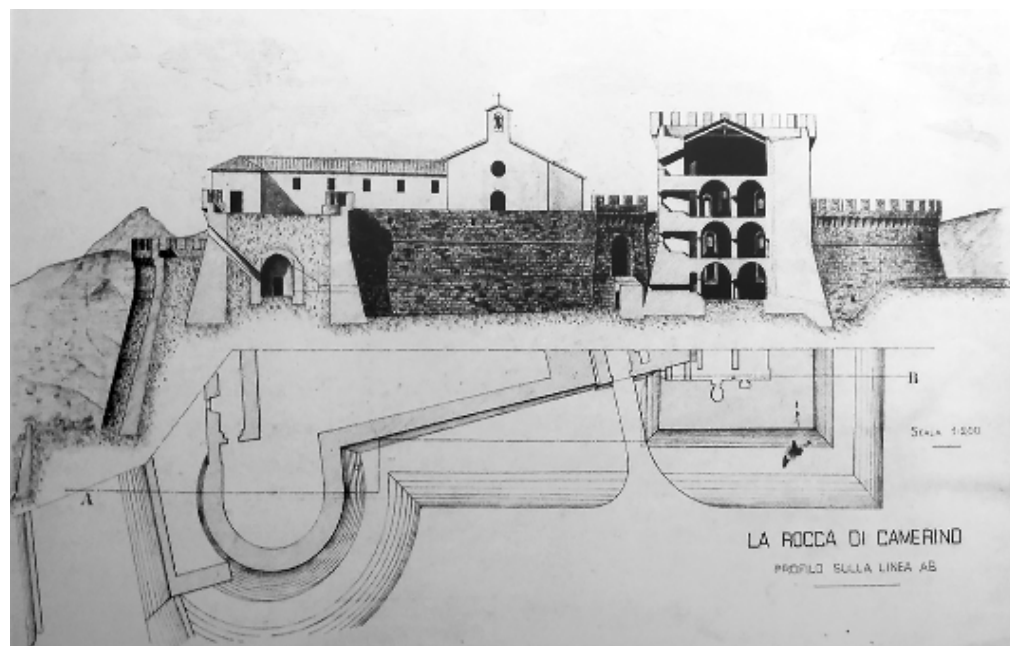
Prospetto-sezione e semipianta della porzione sud della Rocca Borgesca di Camerino (Cruciani, 2002: p. 147)
